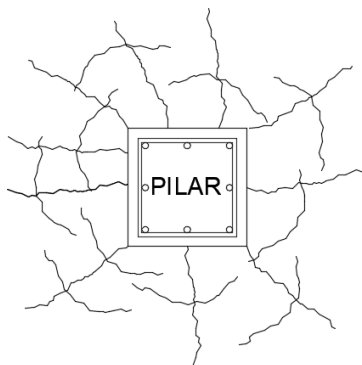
Fissuras de punção na face tracionada da laje
